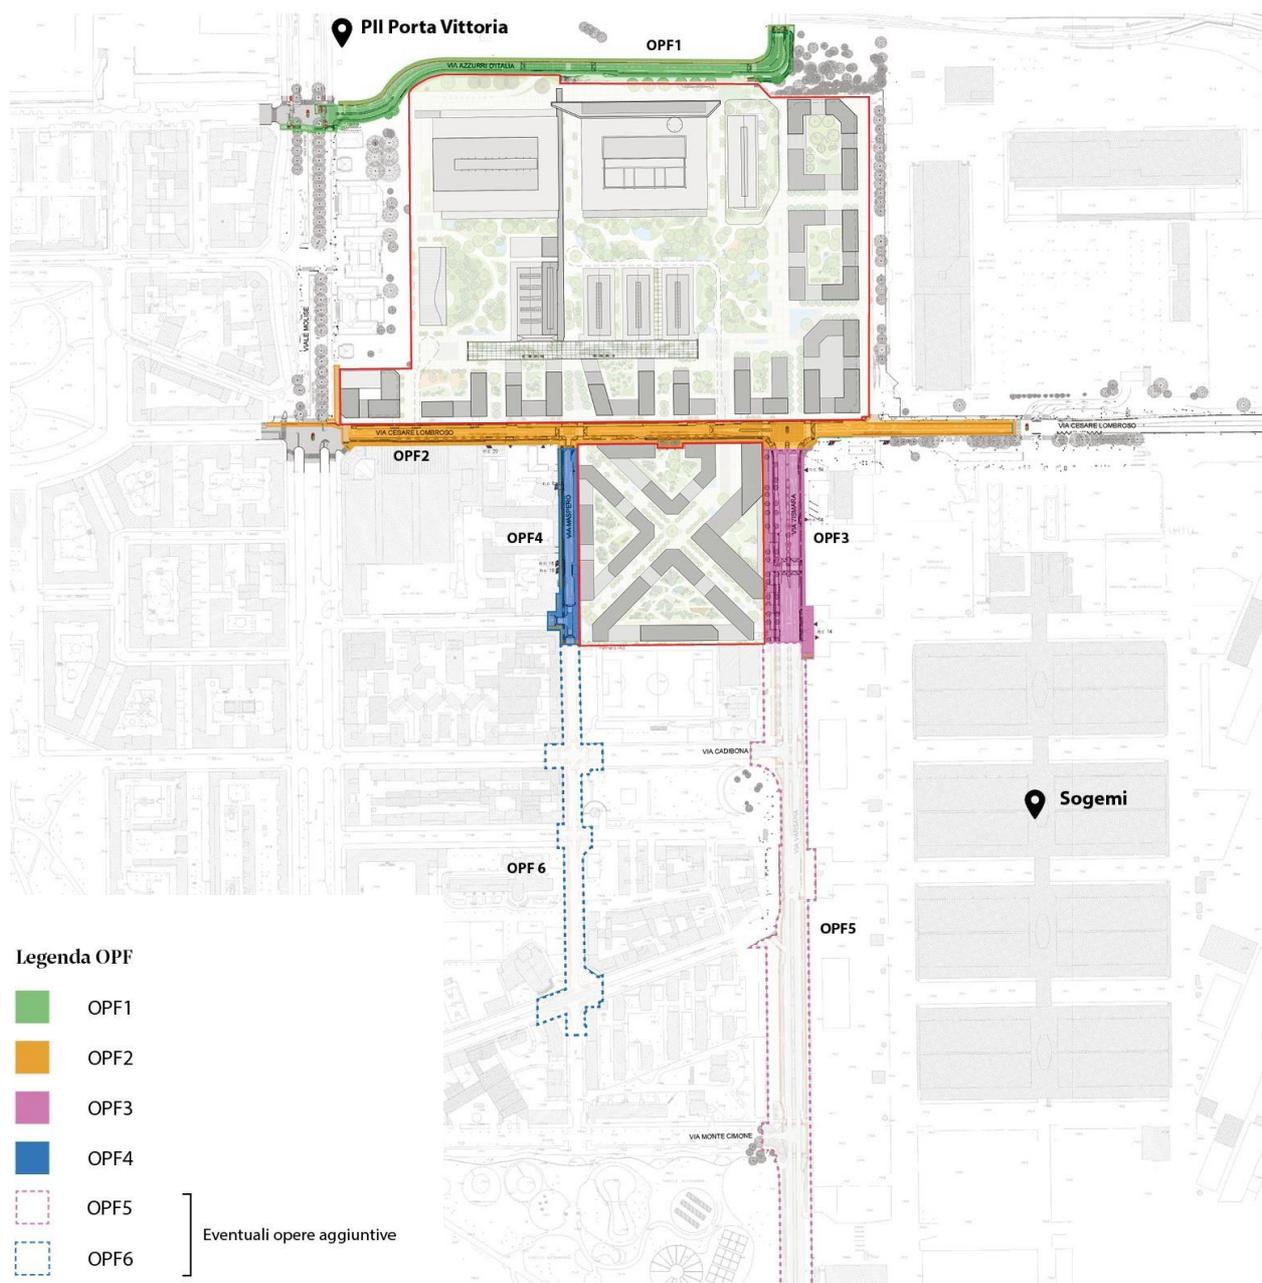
29. Planimetria Opere di urbanizzazione primaria esterne al perimetro del PA3
